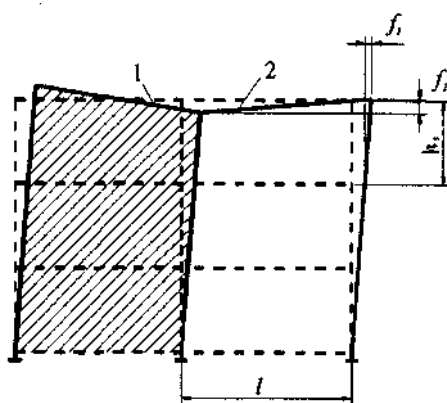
Схема перекося этажных ячеек 2, примыкающих к диафрагмам жесткости 1 в зданиях со связевым каркасом (пунктиром показана исходная схема каркаса до приложения нагрузки)
